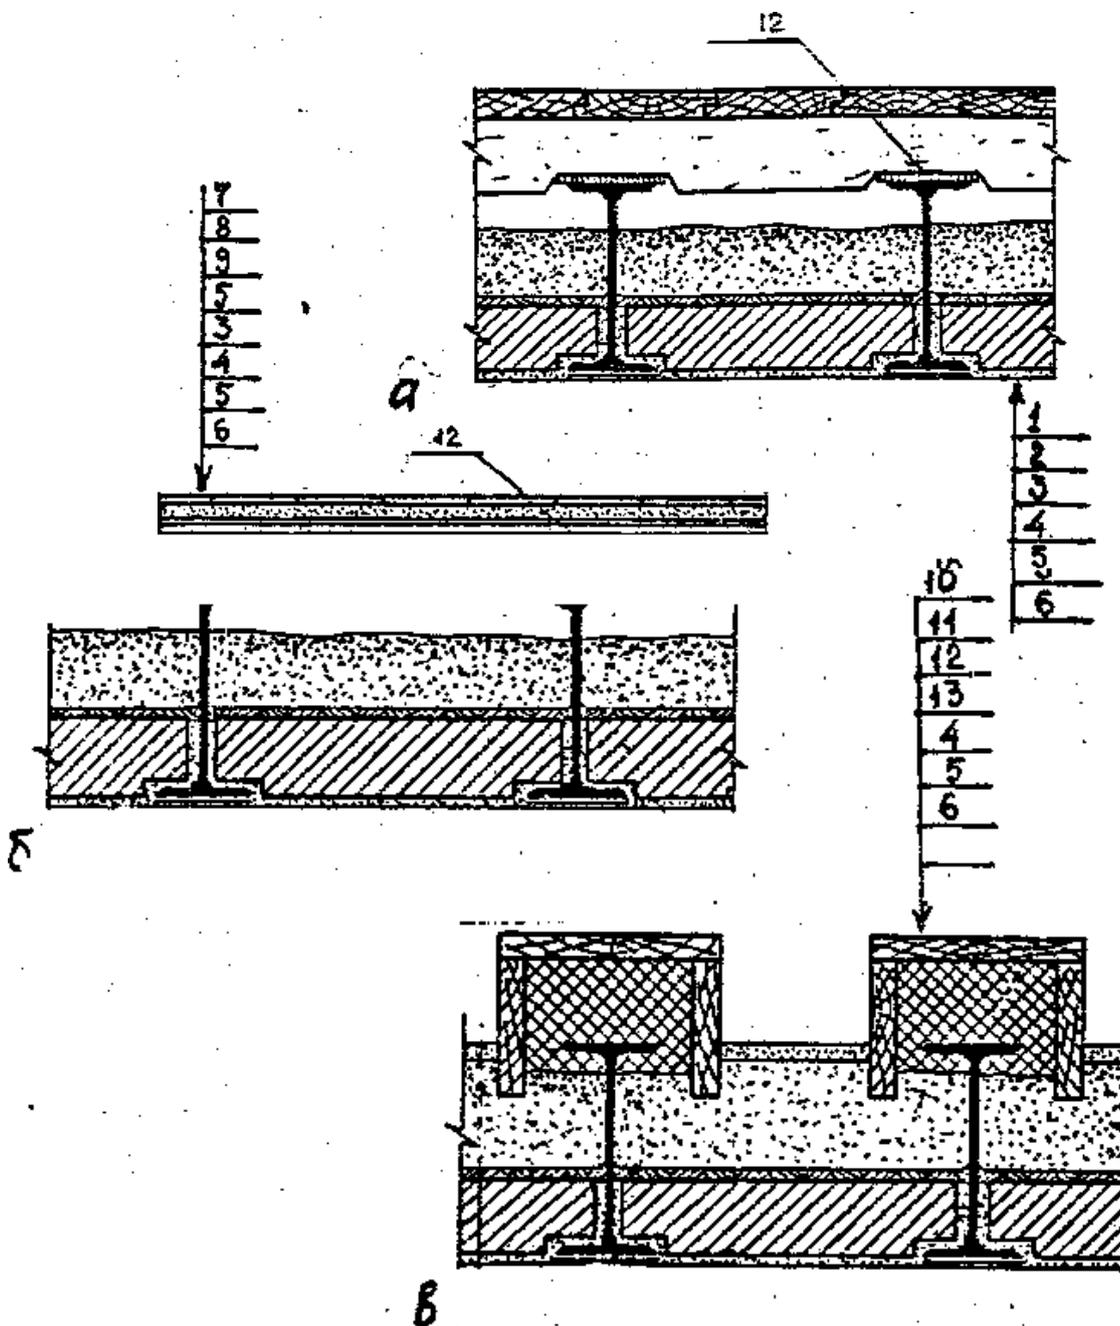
Приклади конструктивного вирішення перекриття по сталевих балках: а - міжповерхове перекриття в житловому приміщенні; б - міжповерхове перекриття в санвузлі; в - горищне перекриття; 1 - дошки - 37; 2 - лага - 70; 3 - пісок - 100; 4 - промазка швів глиною; 5 - залізобетонна плита - 60; 6 - тиньк - 25; 7 - керамічна плитка на розчині - 35; 8 - руберойд на мастиці - два шари; 9 - цементно-піщана стяжка - І5; 10 - дерев'яний короб - 25; 11 - мінеральна повсть - І00; 12 - керамзитовий гравій - 100; І3 - пароізоляція - шар руберойду.
